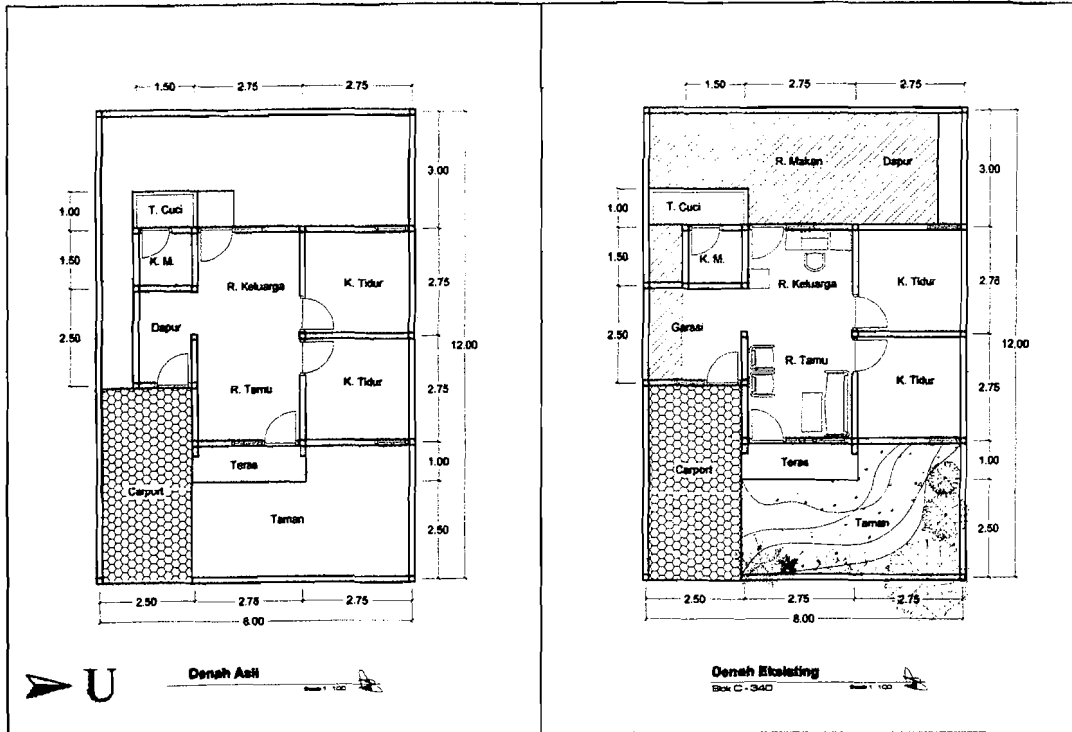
Denah Asli dan Denah Eksisting Blok C 318 yang mengalami penambahan ruang dapur dan pelebaran ruang garasi.
